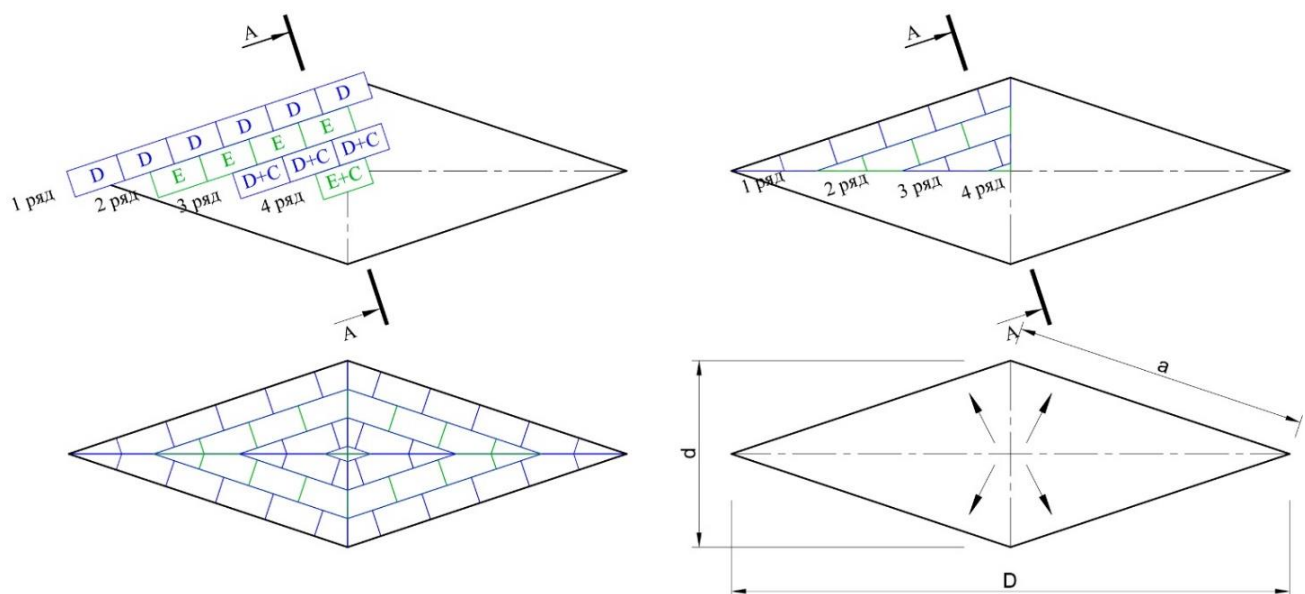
Схема раскладки теплоизоляционных плит для создания уклона в ендове.
